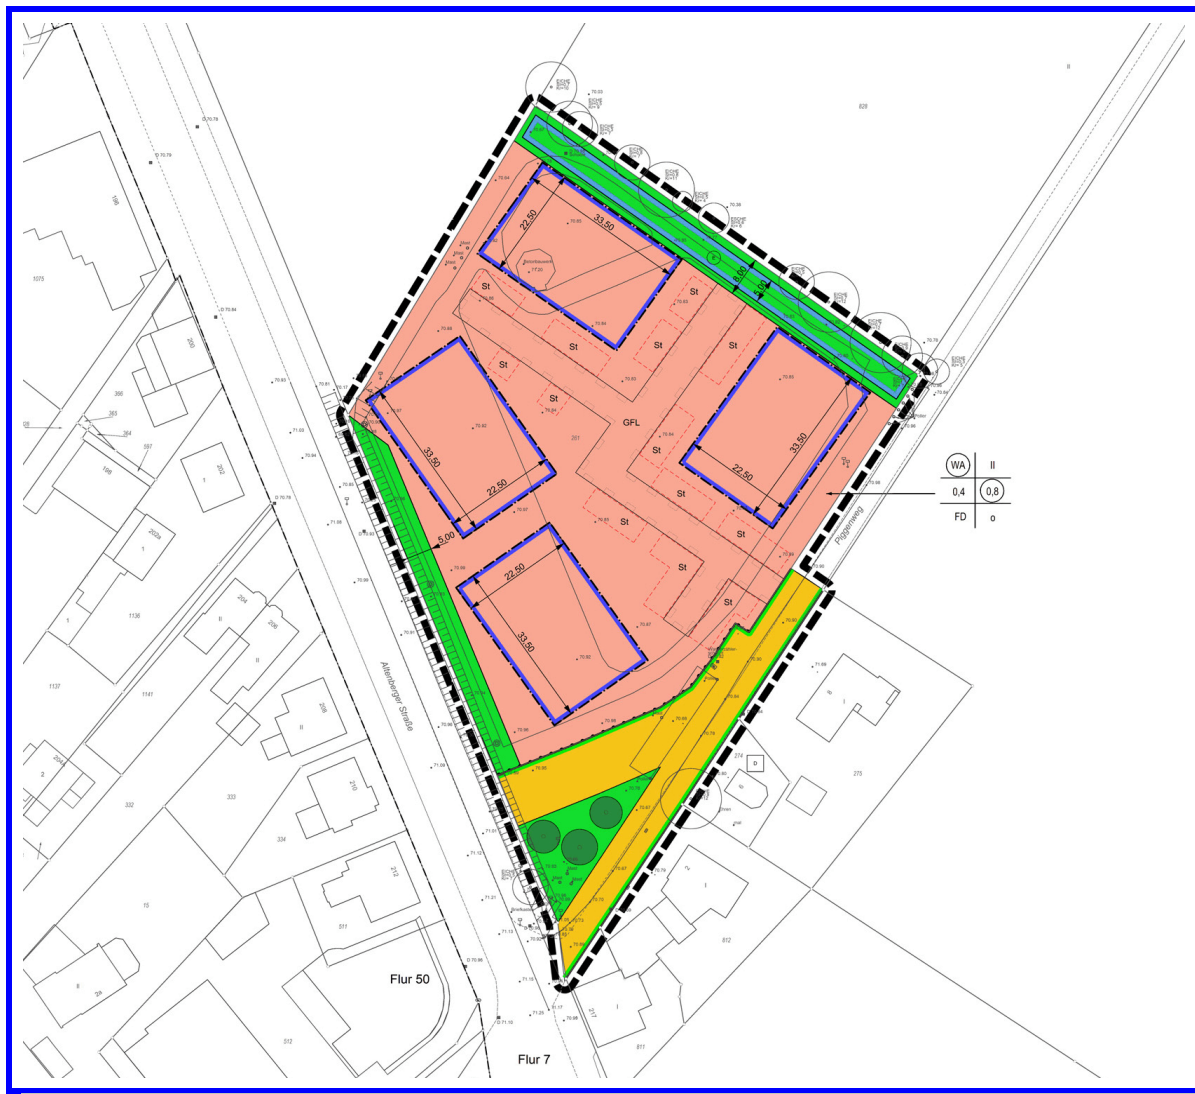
Entwurf des Bebauungsplans Nr. 76b (STADT STEINFURT 2024)
